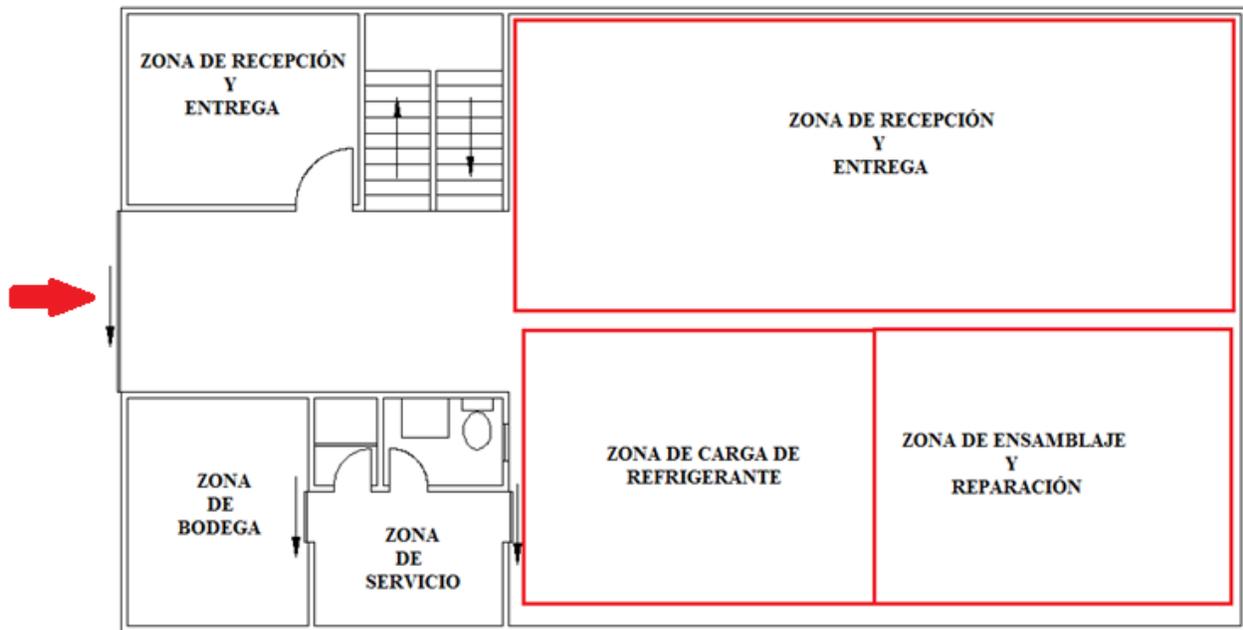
Distribución de áreas de trabajo, planta baja.
